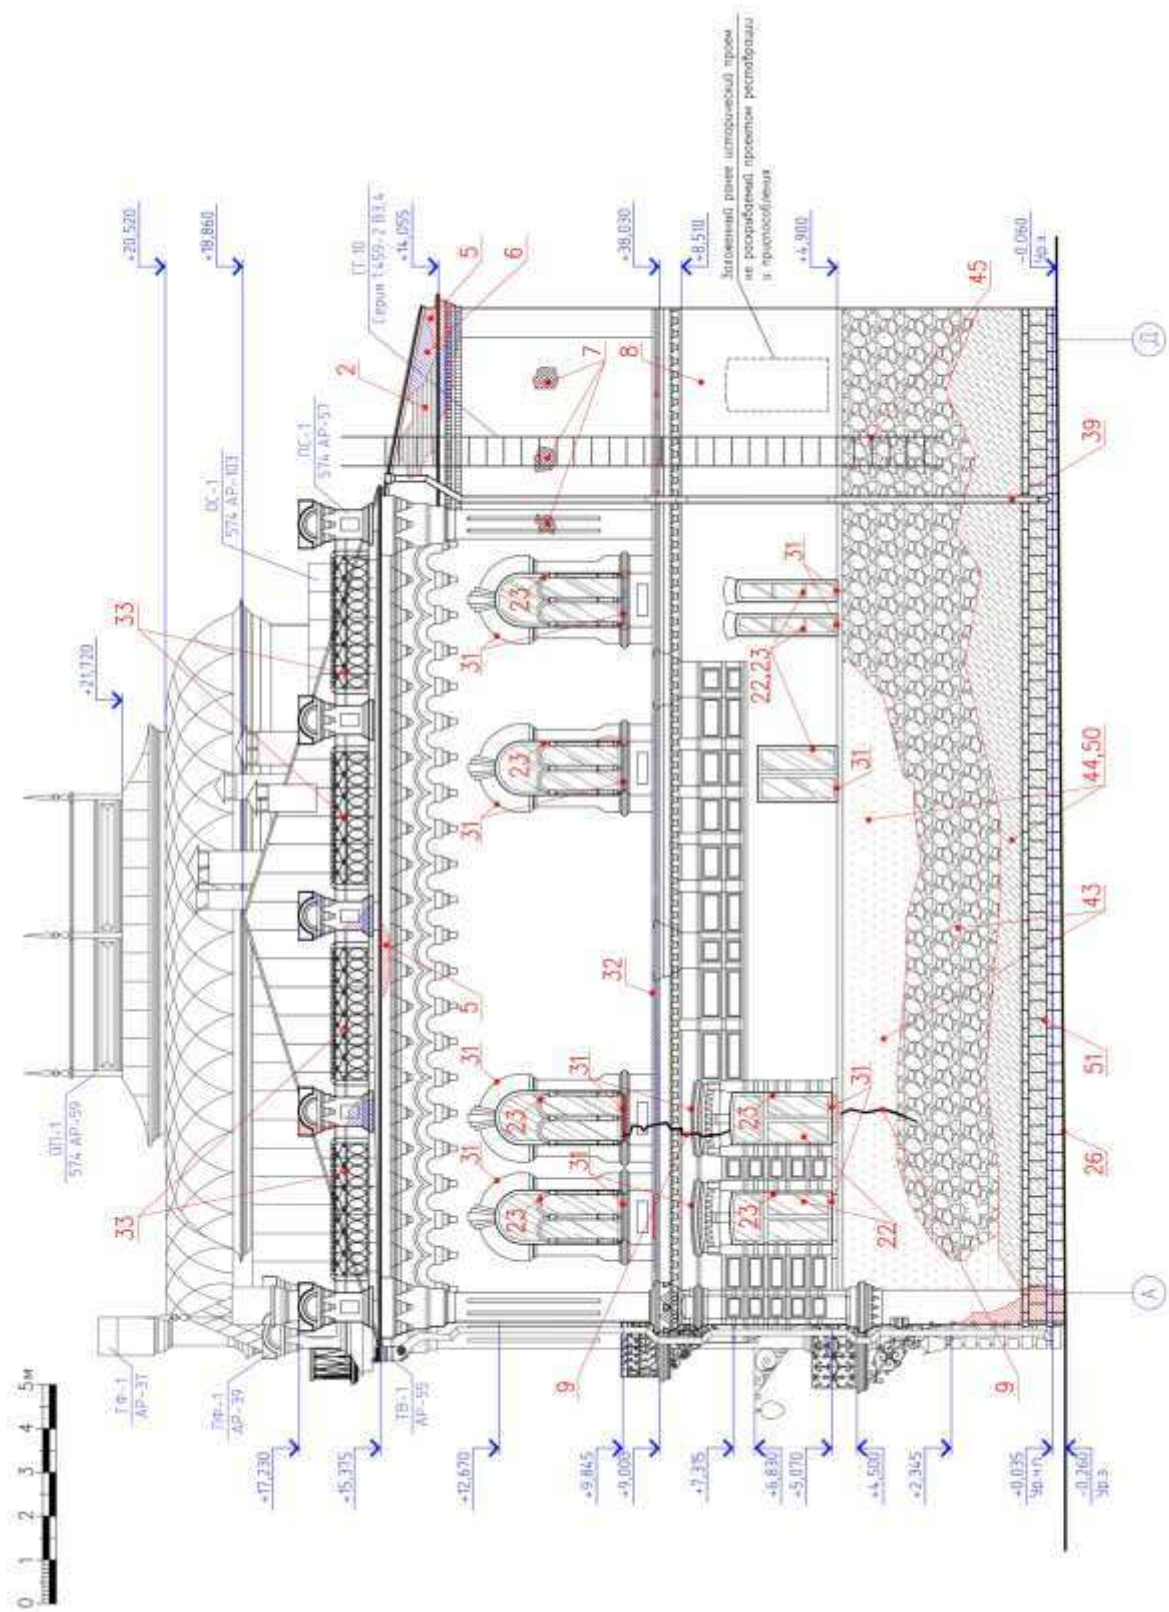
План реконструкции дома Вильнера фасад в осях А-Е
